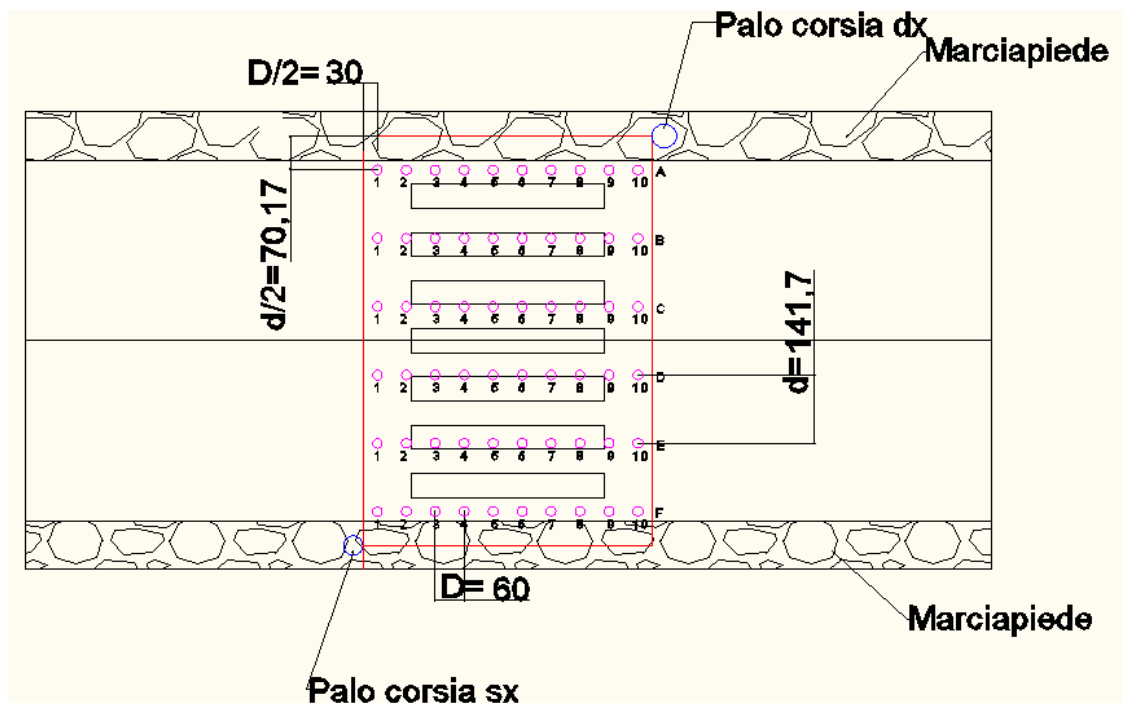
disposizione in pianta dei punti di calcolo per la verifica delle prestazioni illuminotecniche secondo norma UNI EN 13201-3
